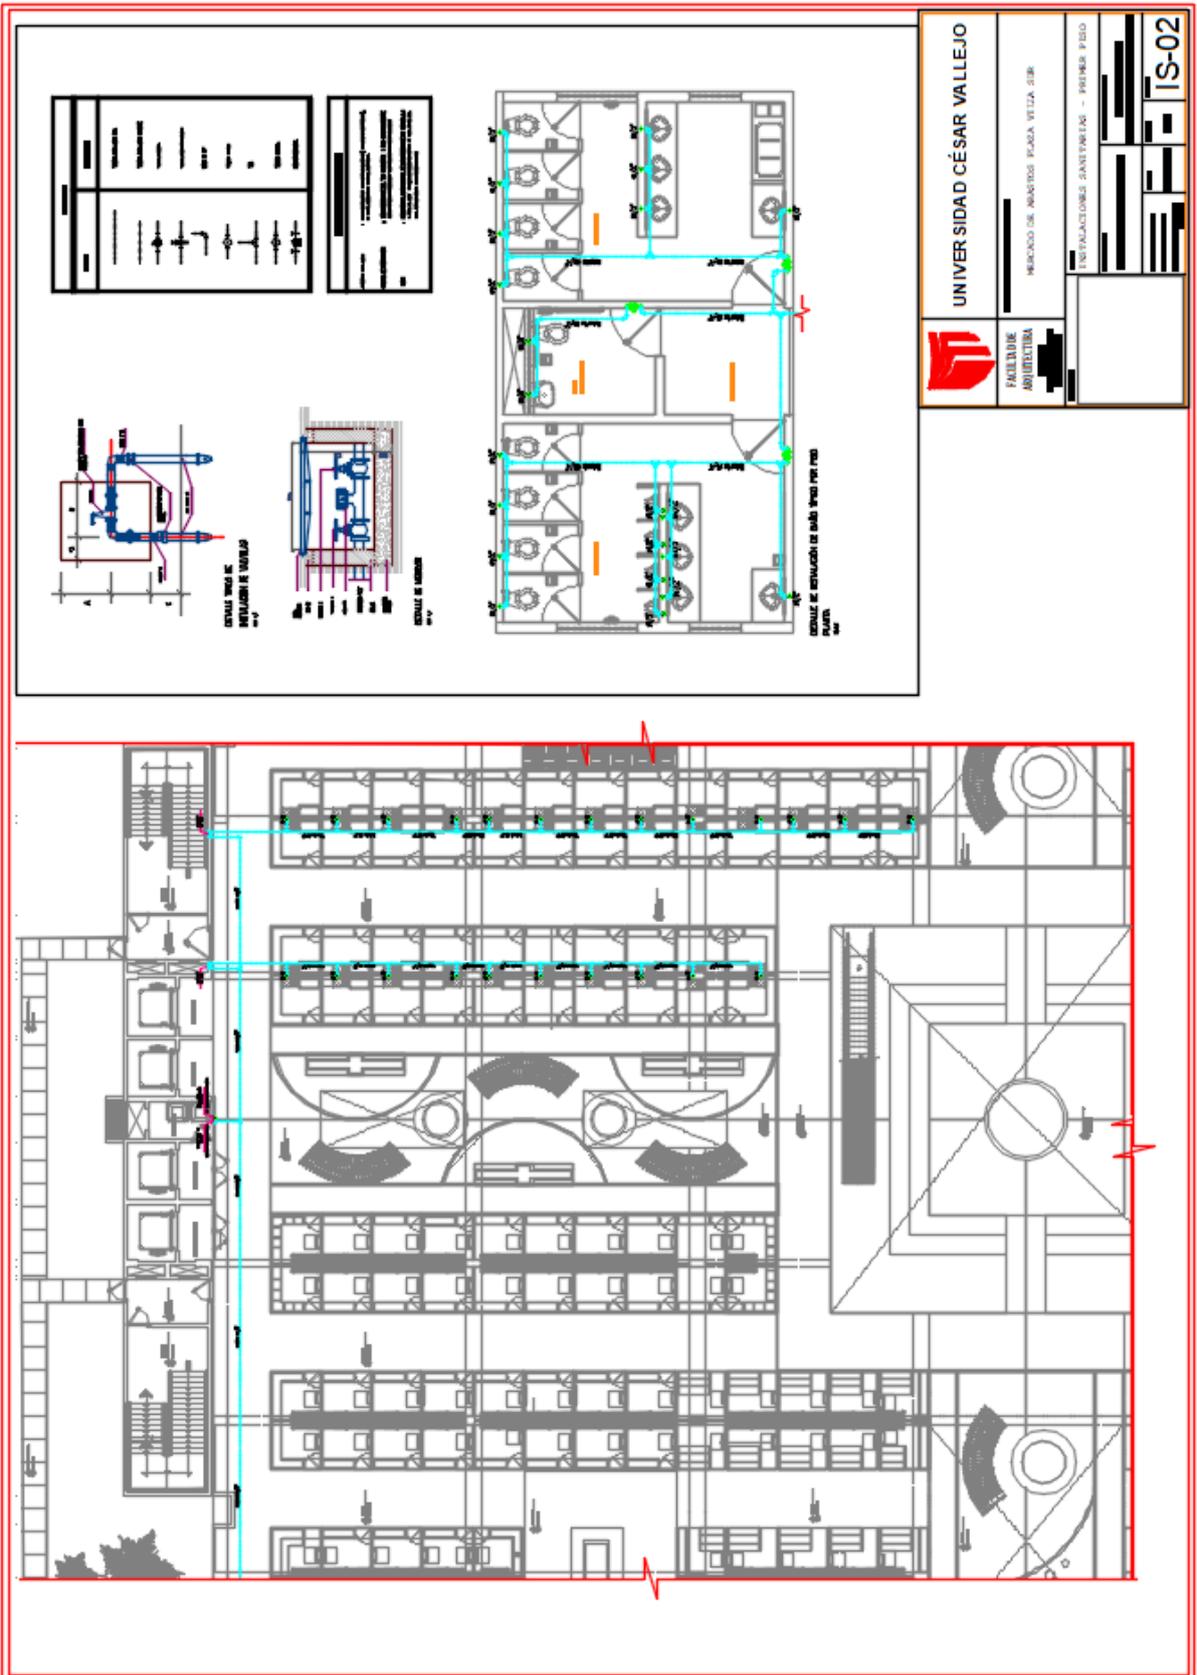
Plano de Sanitarias – Plano de instalaciones de Agua – primer piso.
